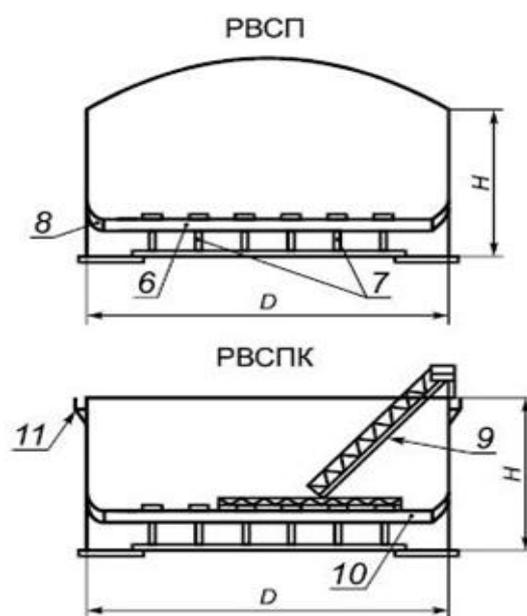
Схема резервуаров с понтоном и плавающей крышей: 6 - понтон; 7 - опорные стойки; 8 - уплотняющий затвор; 9 - катушечная лестница; 10 - плавающая крыша.
